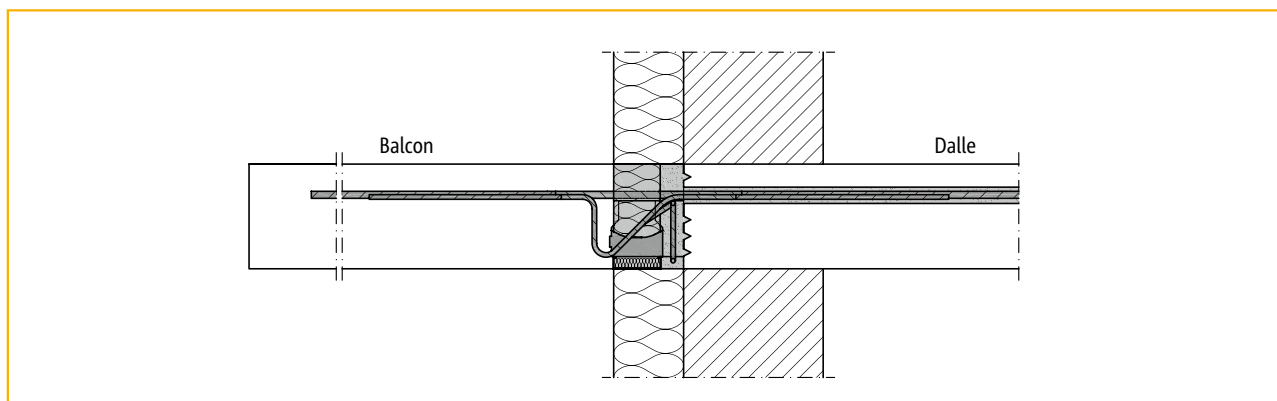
balcon en porte-à-faux avec appui direct lors de la rénovation d'un balcon existant
